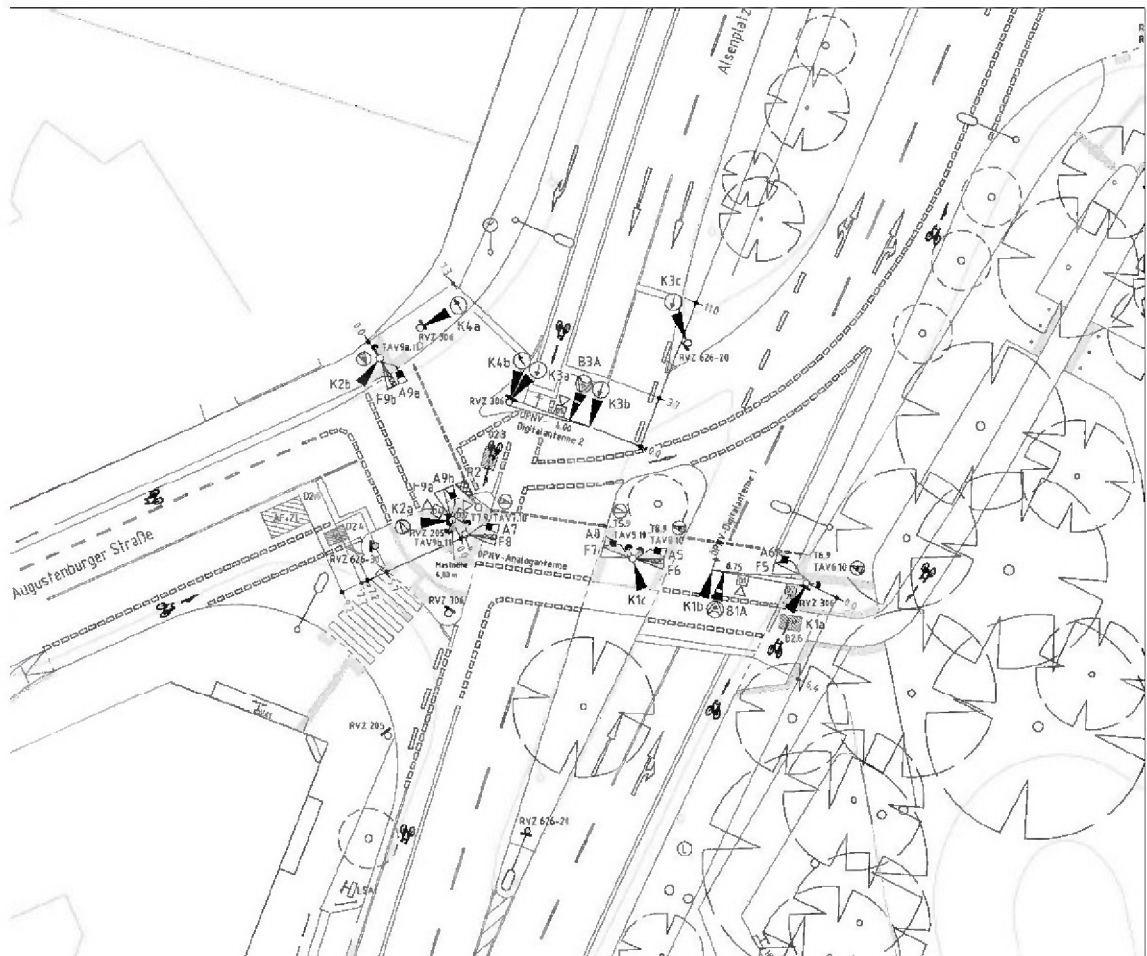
Signallageplan Alsenstraße/Augustenburger Straße – Bestand (17/942-04-04/00)
